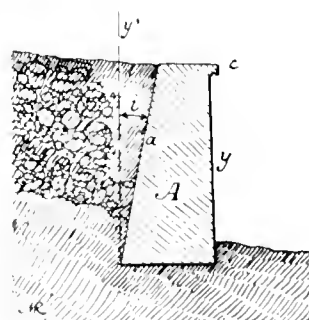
Coupe verticale d'un mur de barrage de torrent.
